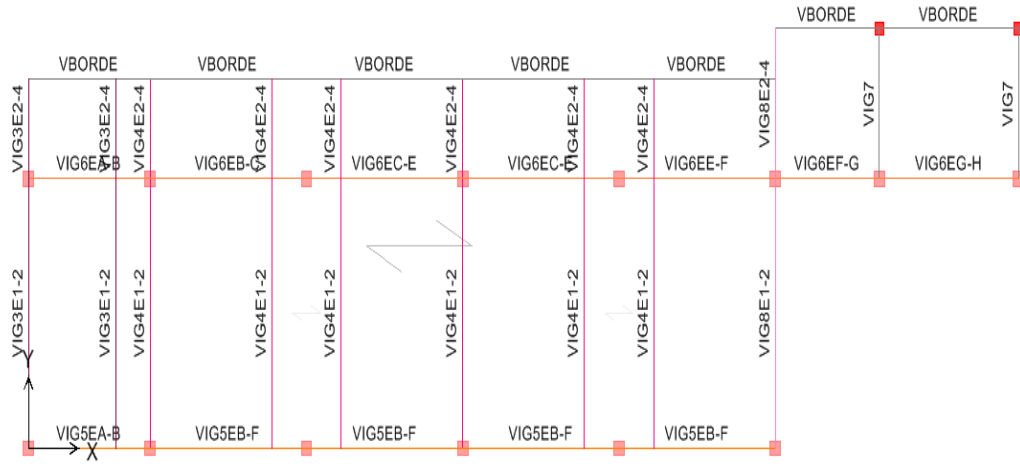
Elementos Tipo Viga – Planta Nivel N+5.6
